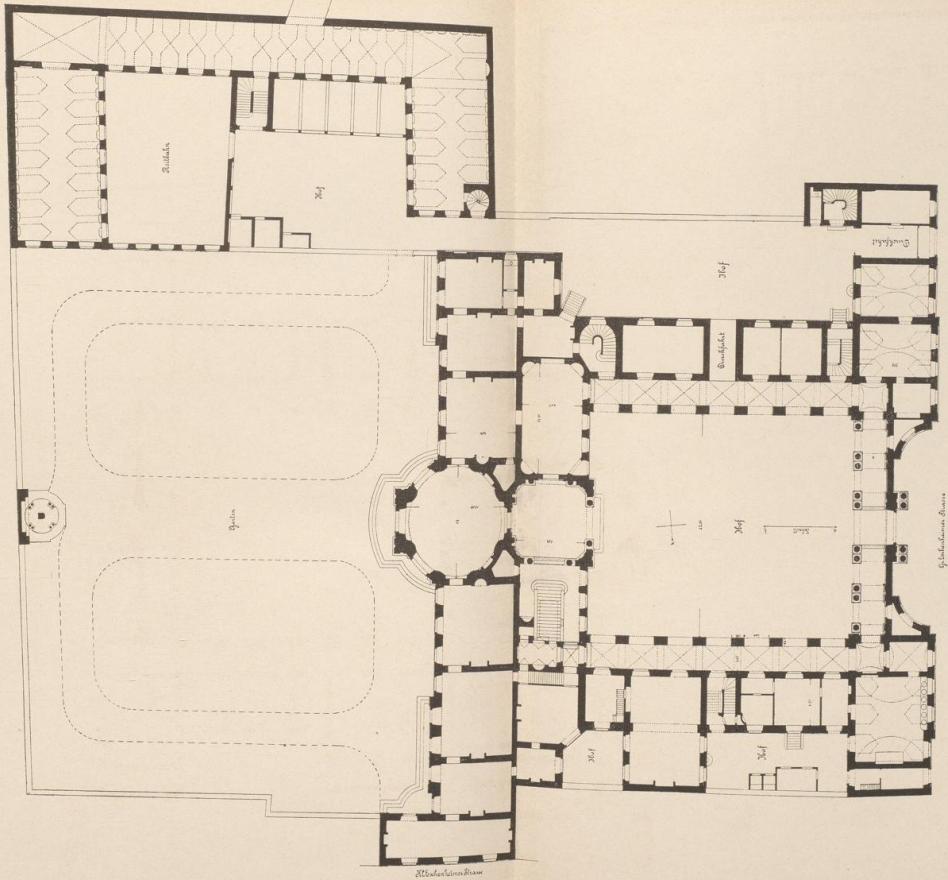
Palais Thurn und Taxis; Grundriss des I. Obergeschosses.
